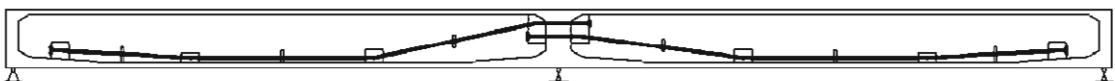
分跨交叉布设体外预应力钢筋示意
